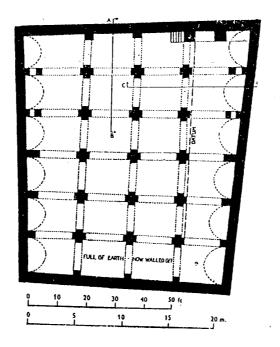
مسقط أفقي لمسجد قصر جبل سيس . (عن : كريزول) .
